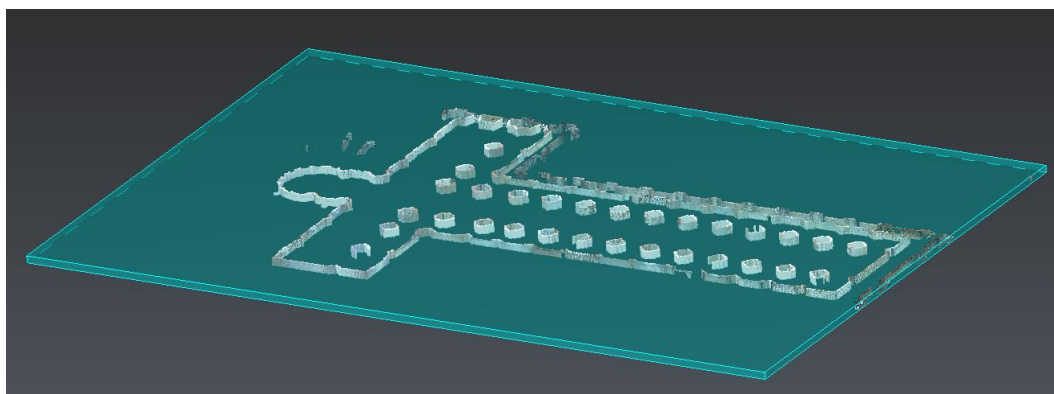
Exemplo de uma *clipping box* com vista à obtenção de um corte em planta da Igreja.
